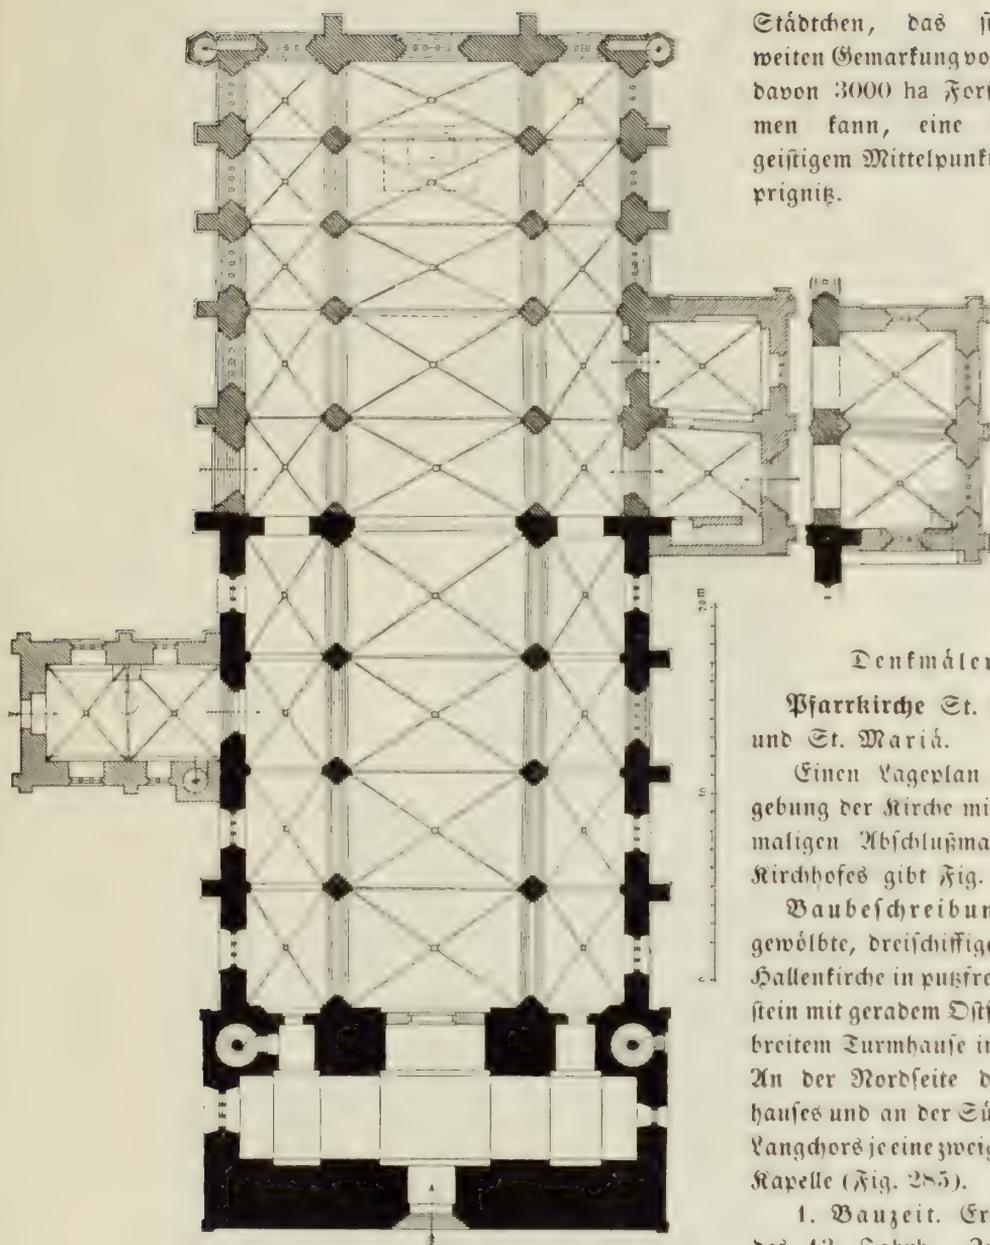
Wittstock. Grundriß der Pfarrkirche.
